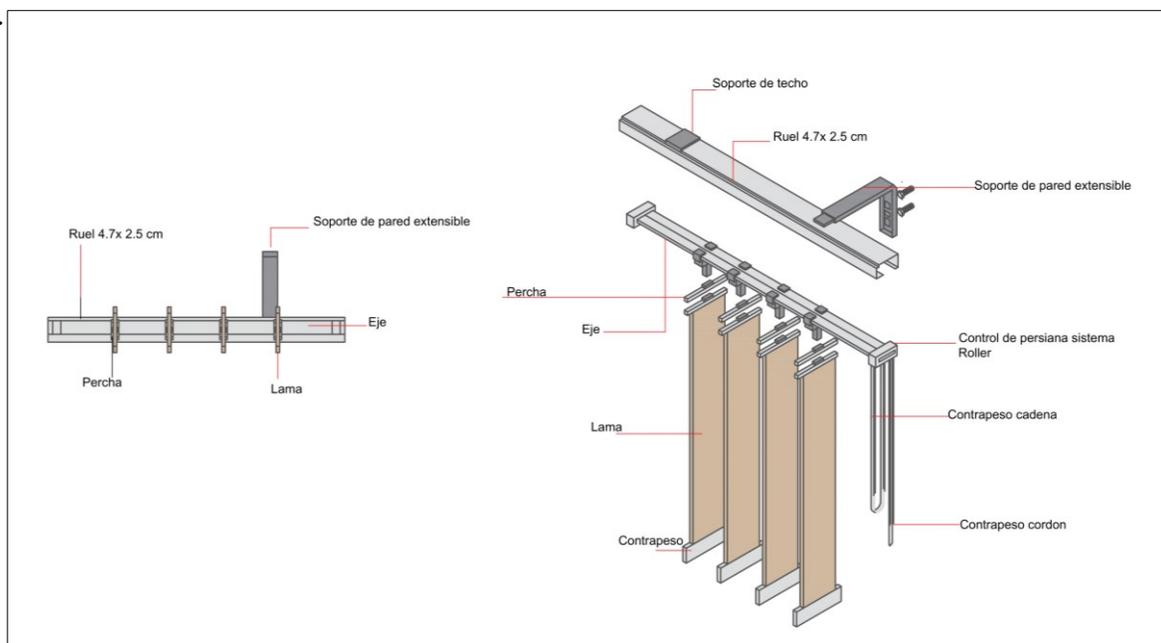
Detalle de brise soleil, Fuente: elaboración propia.
